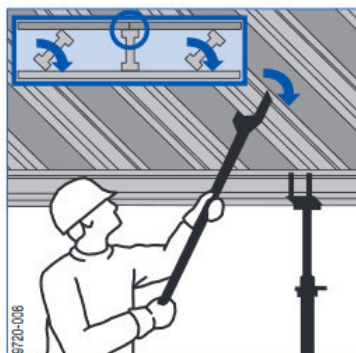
Demontáž univerzálního bednicího úhelníku [1]
